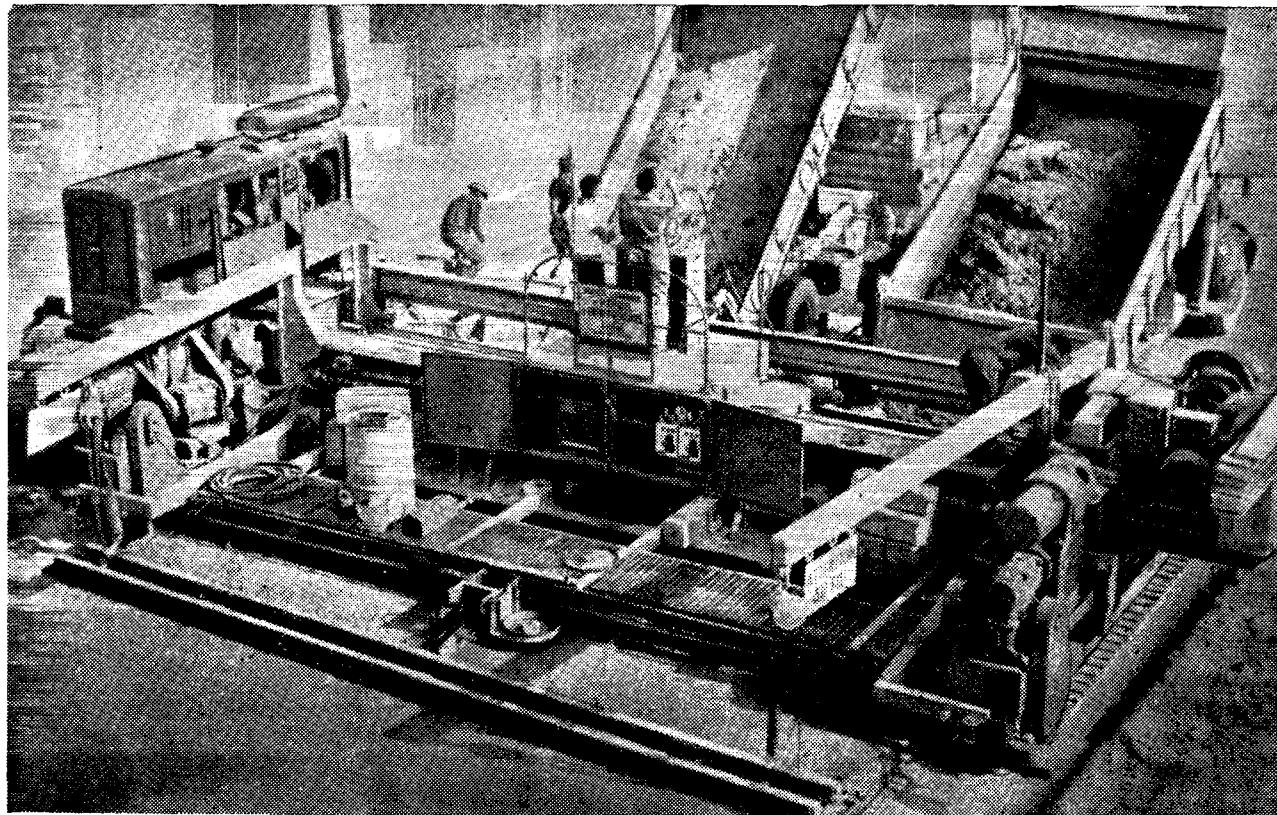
Бетоноукладчик со скользящей опалубкой фирмы Гунтерт-Циммерман
